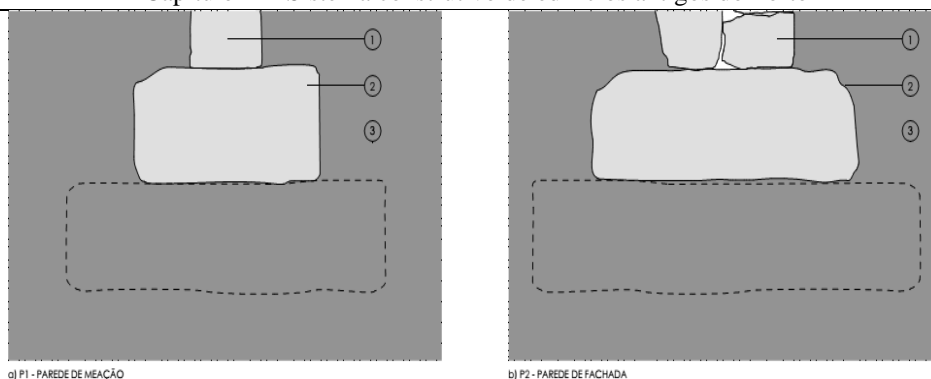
Fundações Directas (Fonte: Teixeira, J. 2014)
